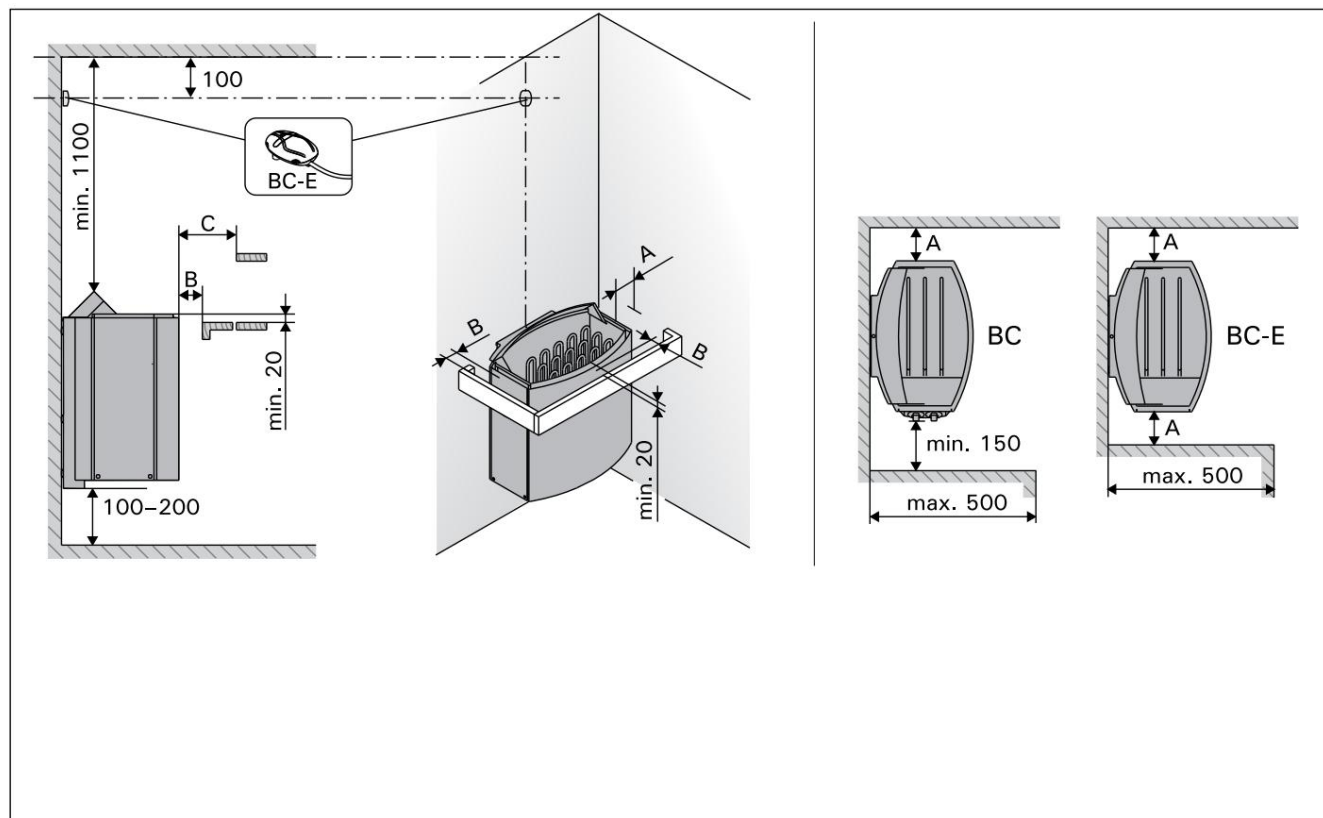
Distanze di sicurezza (tutte le dimensioni in millimetri)
